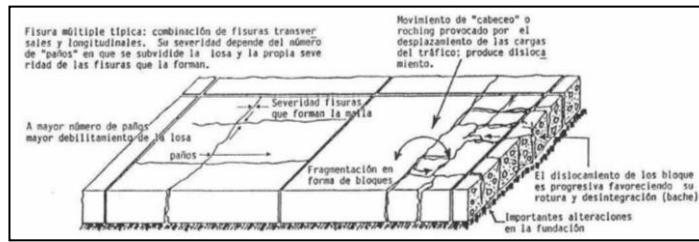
Falla por fisura Múltiple de Pavimento Rígido
